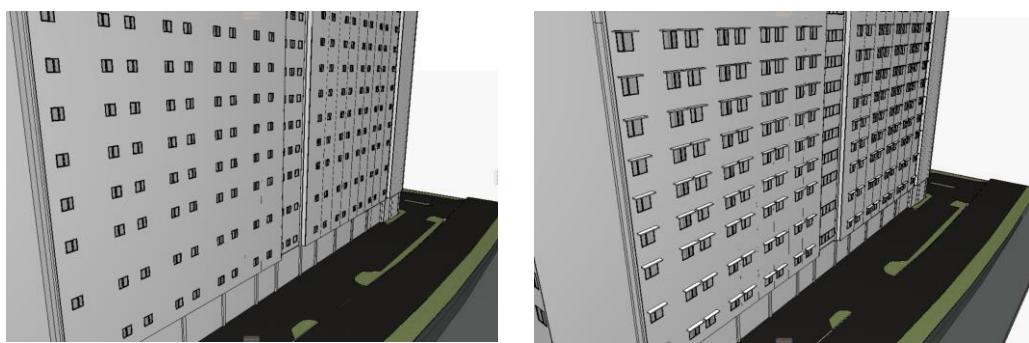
Rencana Blok Emerald Tower & Beton *Prefab* Tembok
